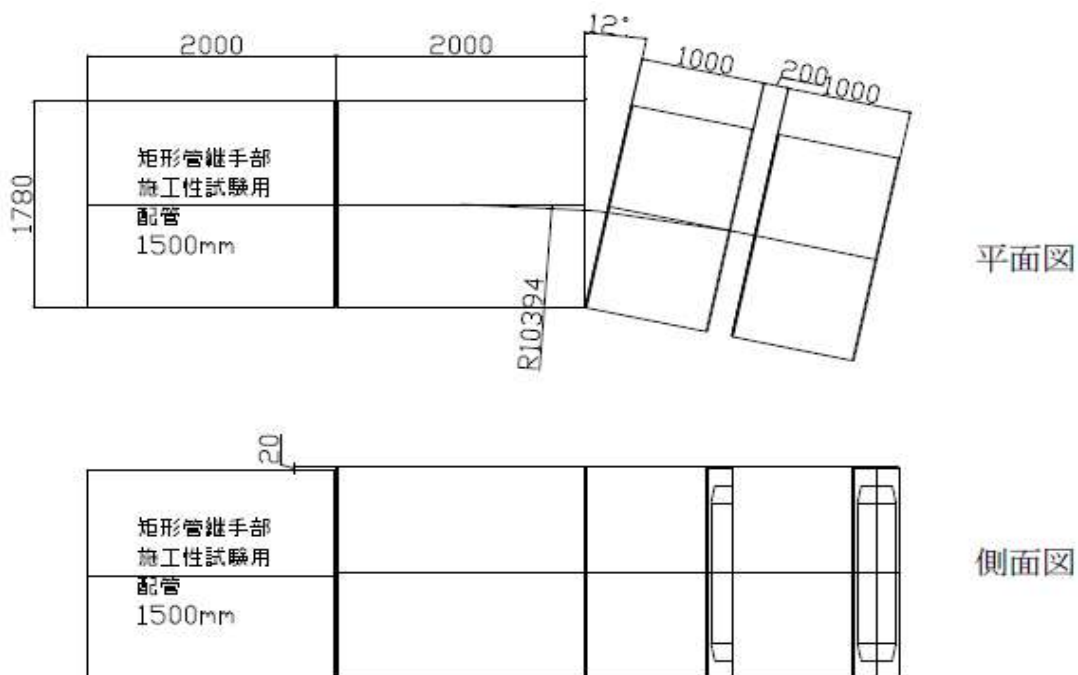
矩形管継手部の施工性試験の配管図 (単位 mm)
